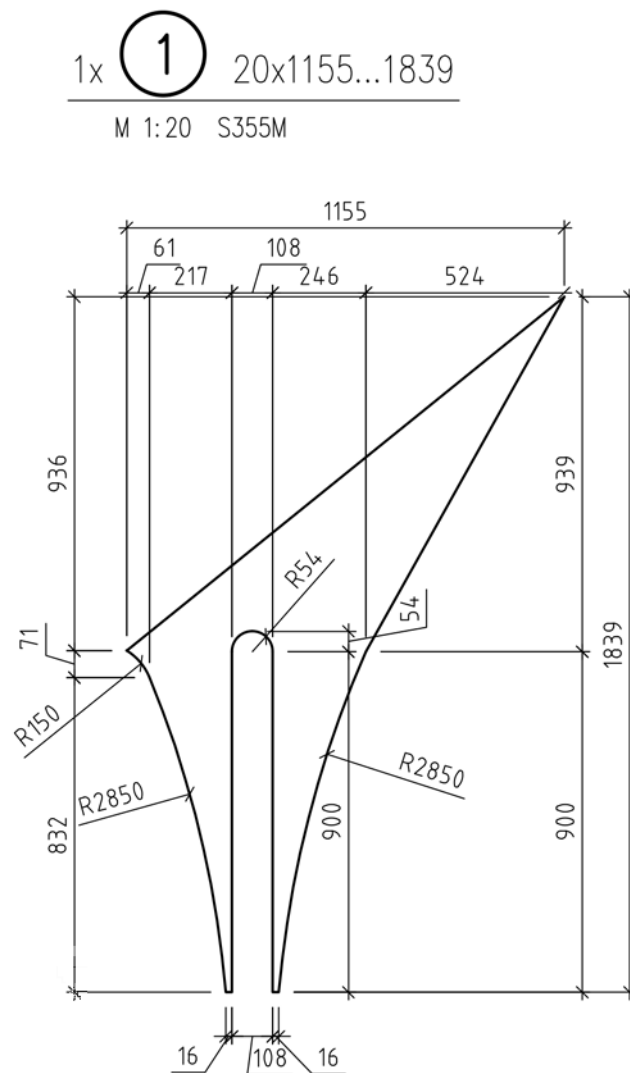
Oberes Knotenblech vom geschweißten Hänger 3a01
